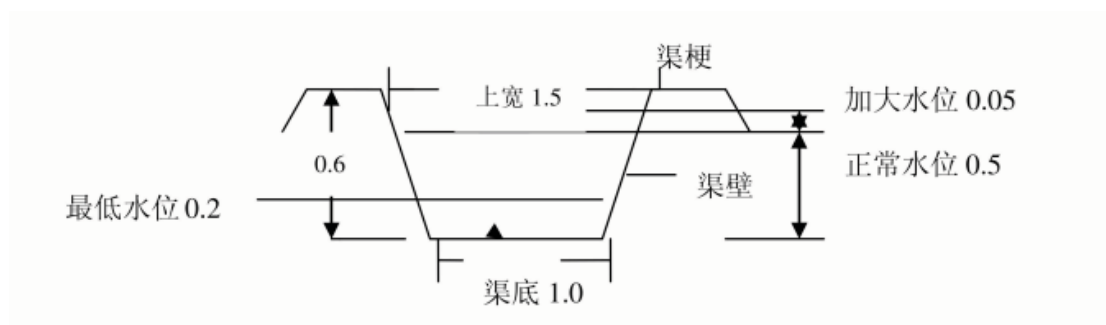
生态沟渠断面示意图（单位：m）
